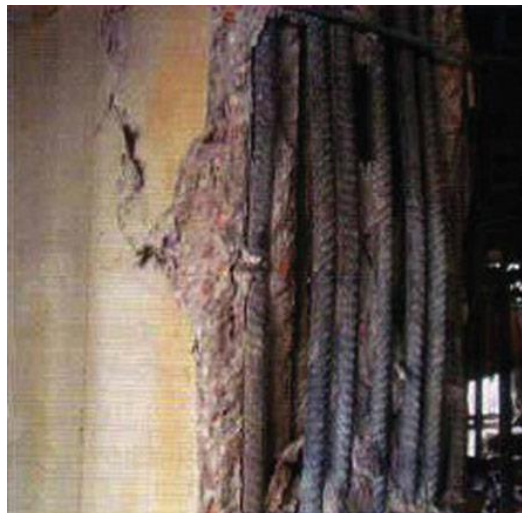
Face estilhaçada de betão – efeito *spalling*.
